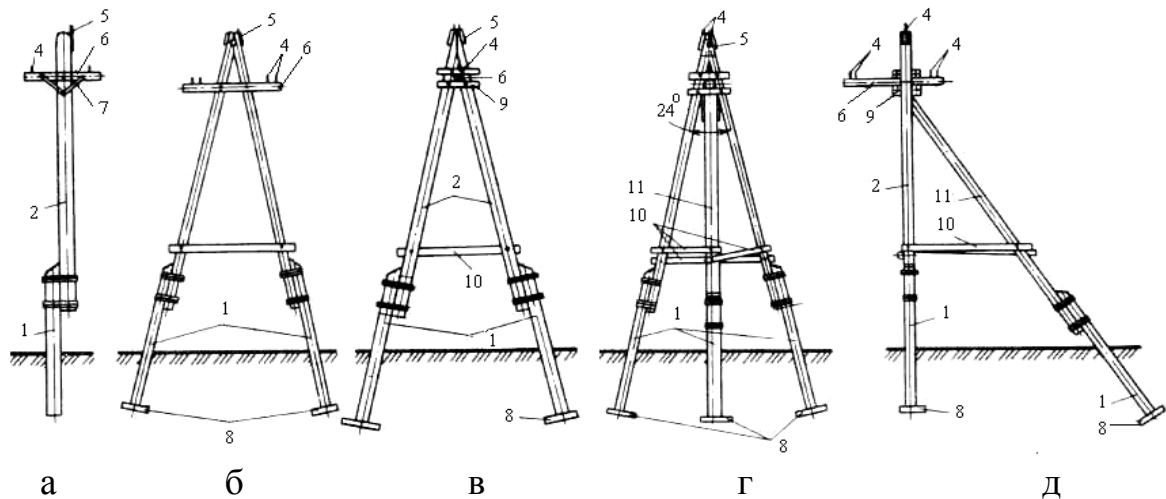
Дерев'яні опори ПЛ на напругу 6-10 кВ:
